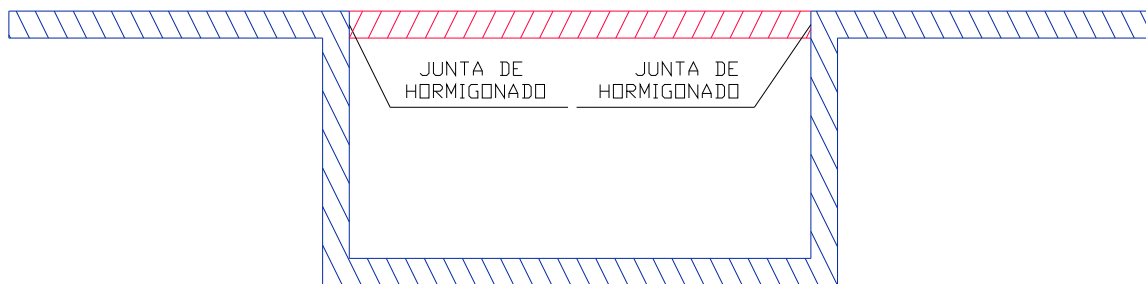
12. Junta de hormigonado planteada por Mecanotubo (1º fase en azul y 2º fase en rojo).
